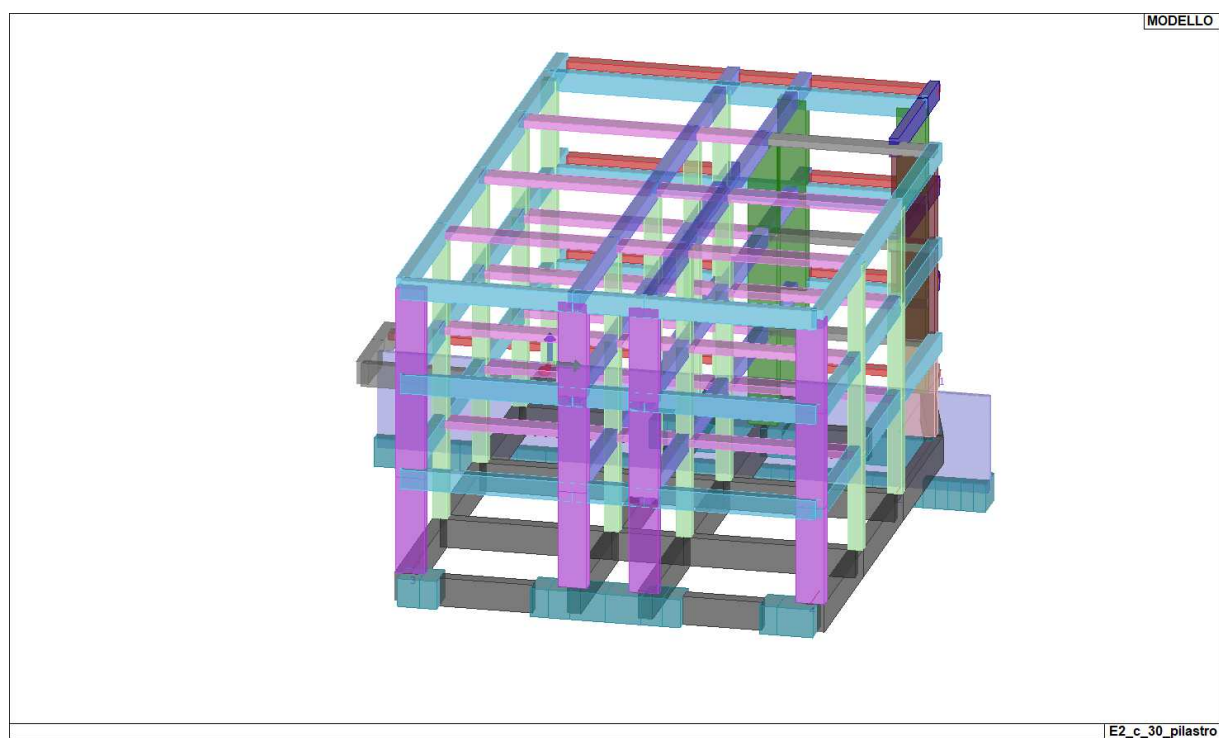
Vista assonometrica modello struttura in elevazione – solo travi/pilastri
